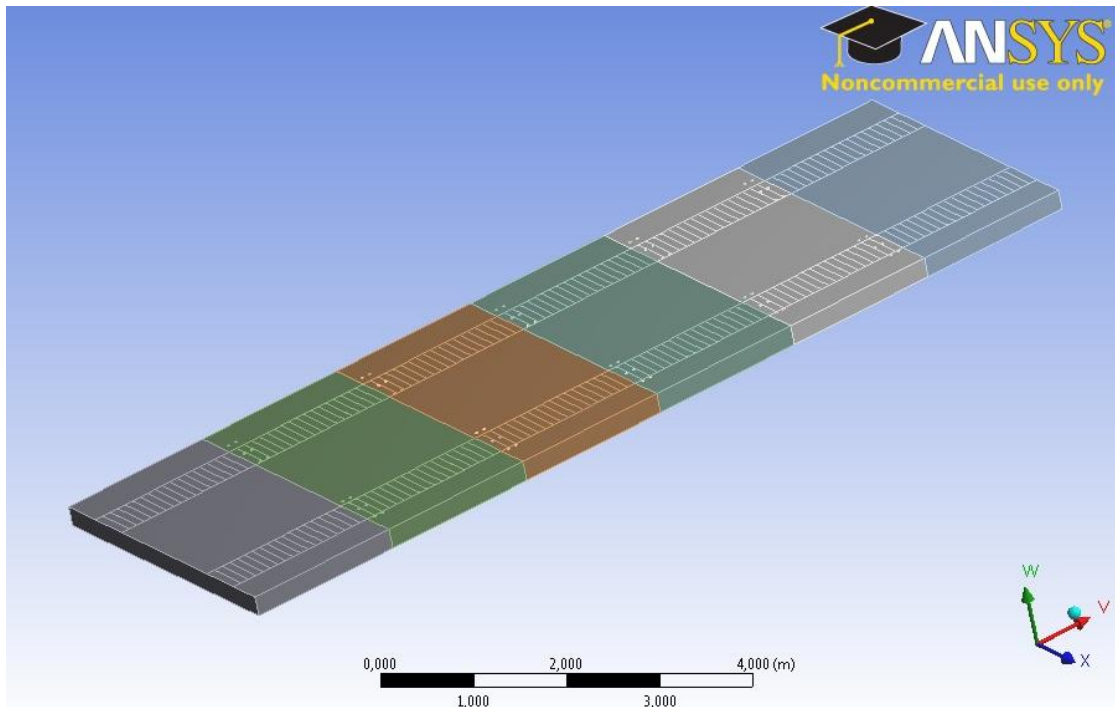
Sistema ranuras - barras de paneles prefabricados.
